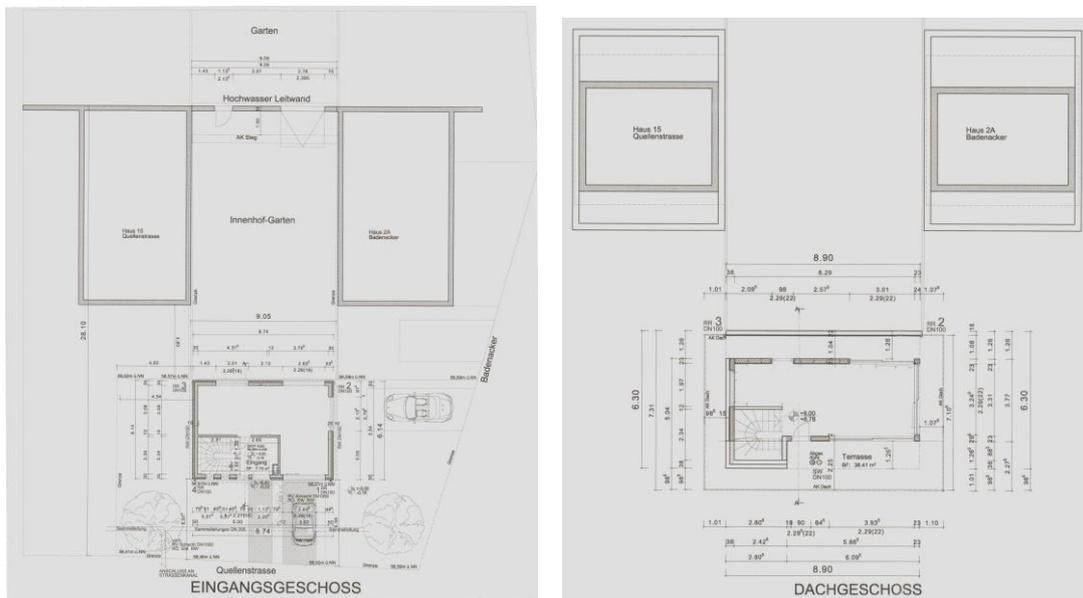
Grundrisse Eingangs- und Dachgeschoss
